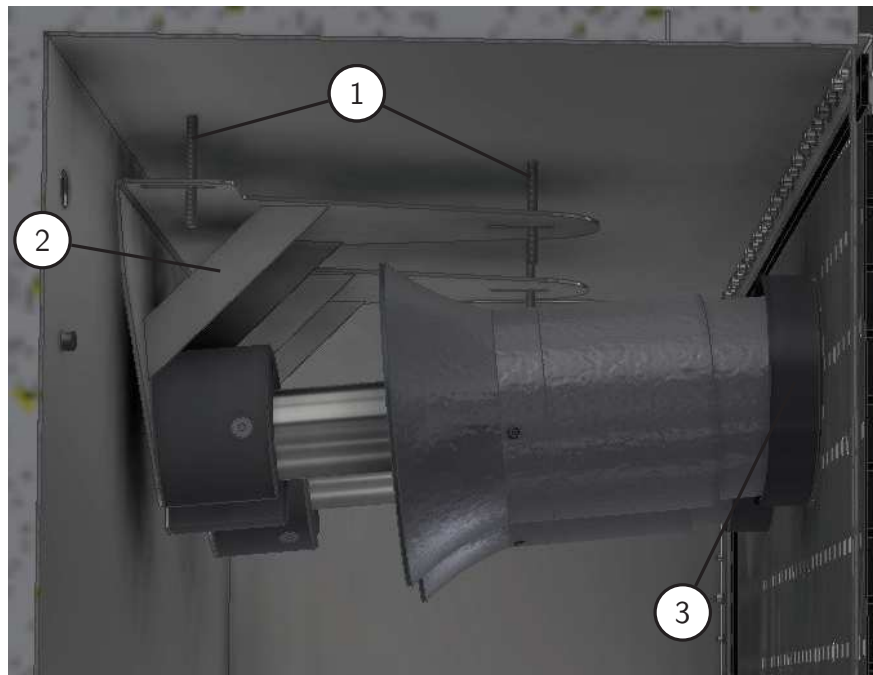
Ausschnitt aus einem Einbauschacht mit Stehbolzen ①. Zur Montage der Turbine wird die Turbine auf den Winkel ② geschraubt. Der Winkel wird an den Stehbolzen mit Muttern montiert. Dabei ist darauf zu achten, dass die Turbine später durch die Ausströmhilfe ③ im Abdeckblech geführt wird.
